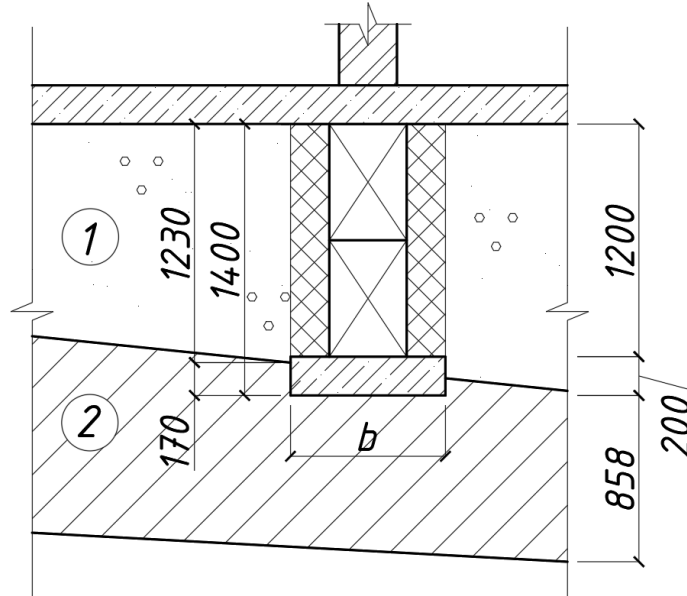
Розрахункова схема фундаменту під внутрішні стіни.
